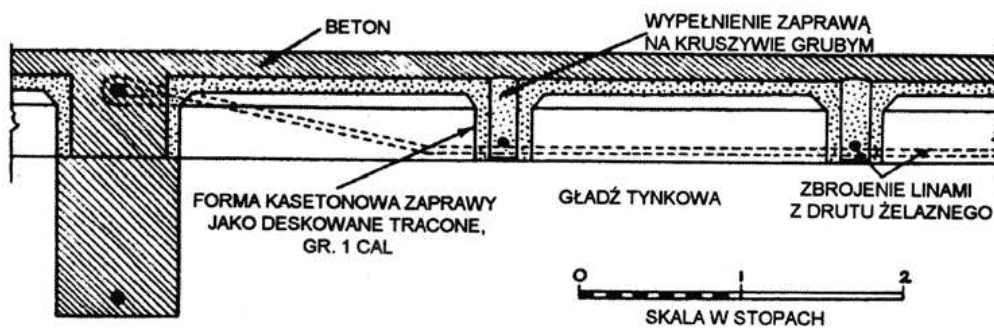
Konstrukcje z betonu zbrojonego opatentowane przez Moniera [1]
